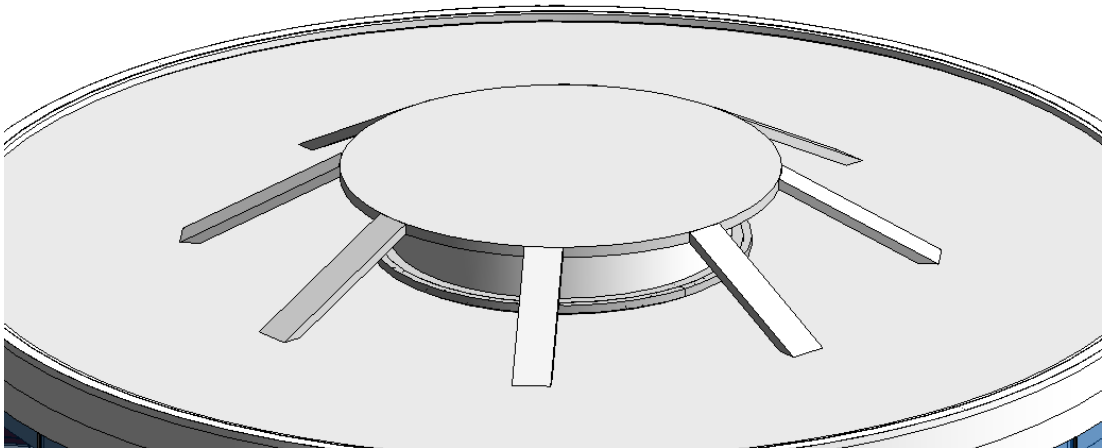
Estructura de la cubierta del edificio (Vista 3D)
